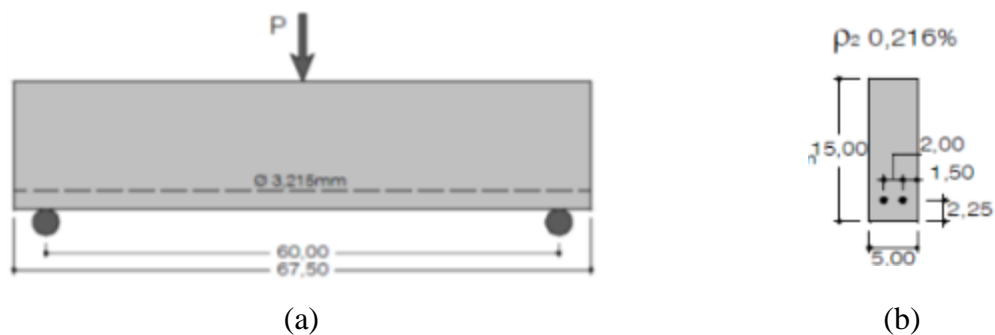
(a) Viga R2-b e (b) seção transversal da viga (MELO, 2011).
